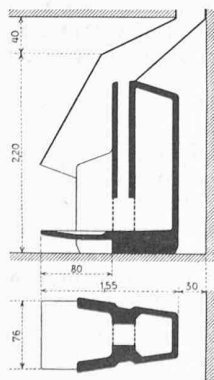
Kamin-Ofen. Grundriss u. Schnitt 1:80
